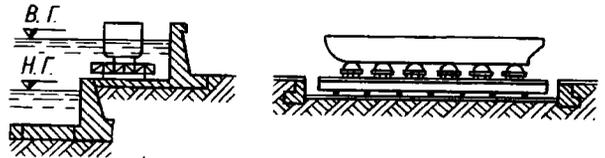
Камера дока, оборудованная металлическими кильблоками
